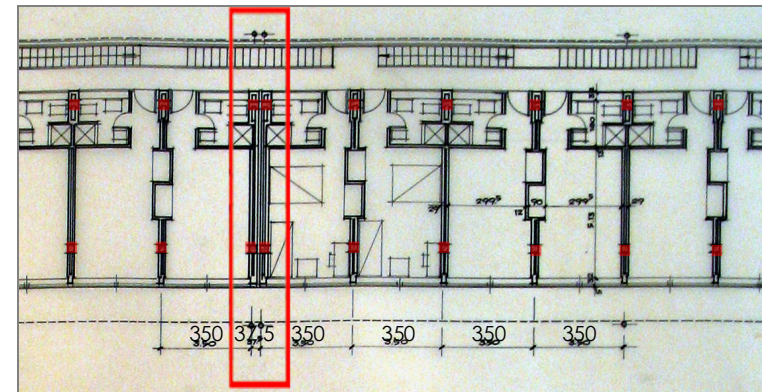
l'interasse dei pilastri e il giunto strutturale (fonte CSAC – archivio n.276-1, rielaborazione f.m.)
